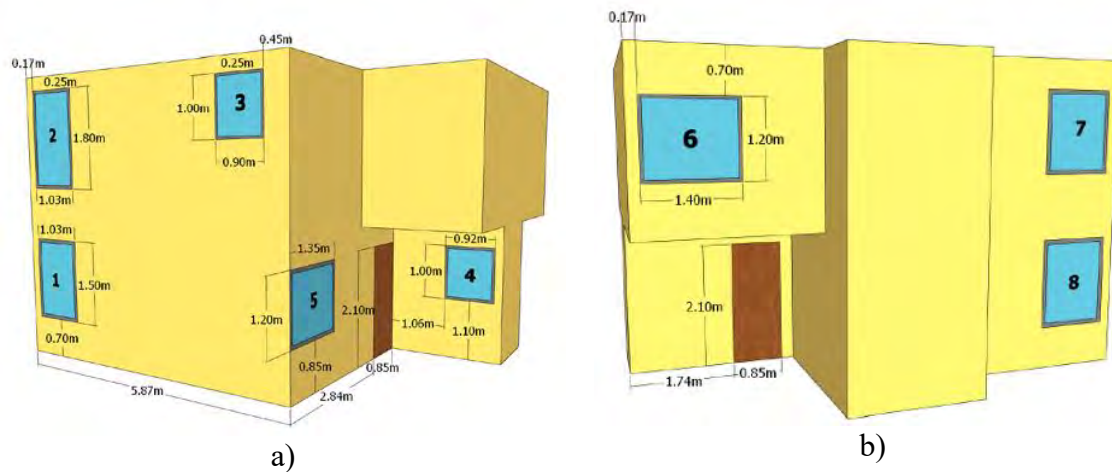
Fachadas de la vivienda: a) sur, b) norte
